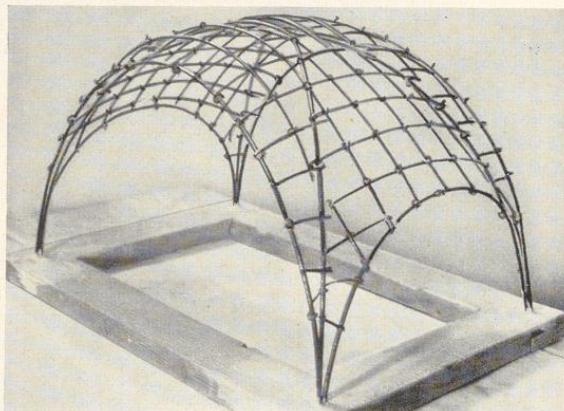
Drahtmodell für Stutzkuppel über rechteckigem Grundriss
